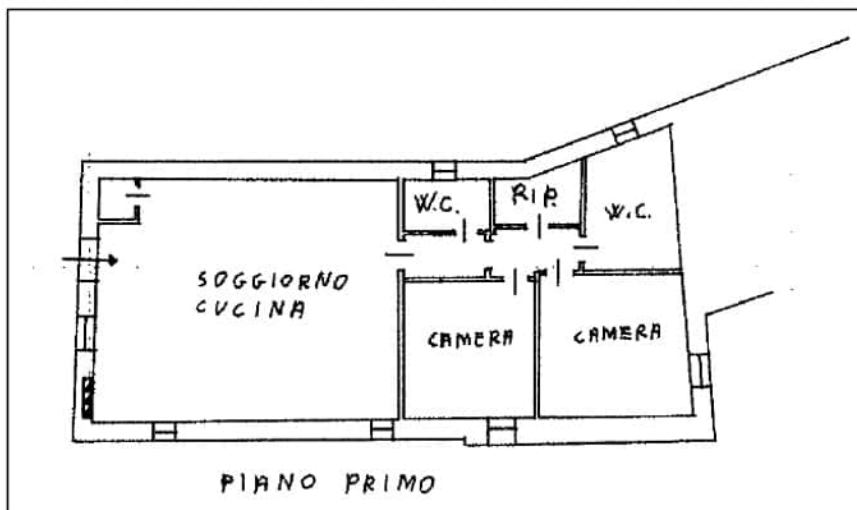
planimetria dell'abitazione al piano primo della particella 308 sub 2
